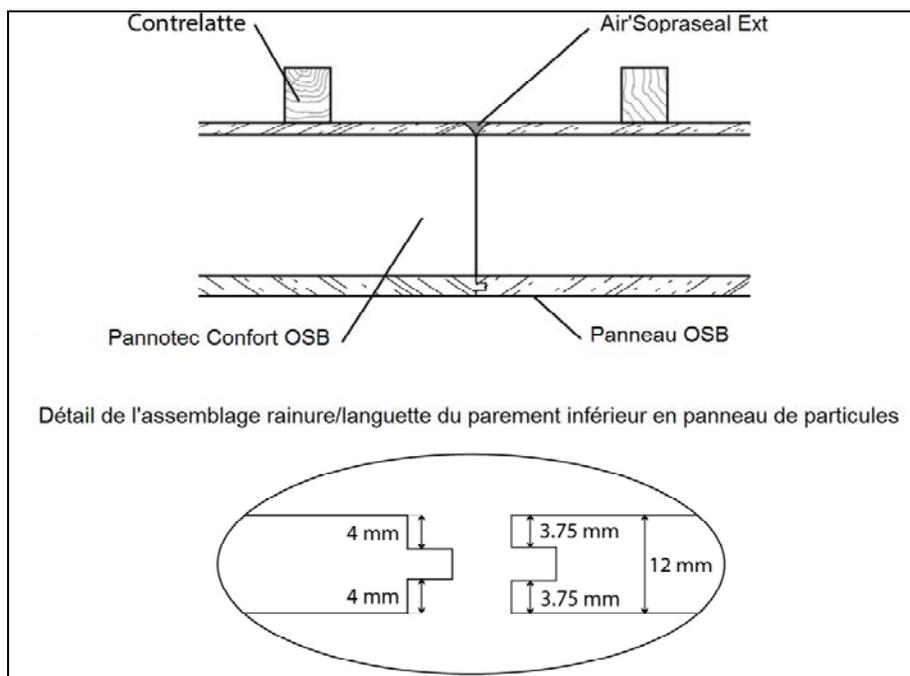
Assemblage des éléments PANNOTEC® CONFORT OSB
